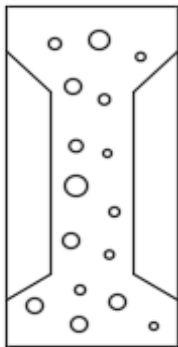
Temel soketi kolon bağlantısında betondan yapılan rijit bağlantı
